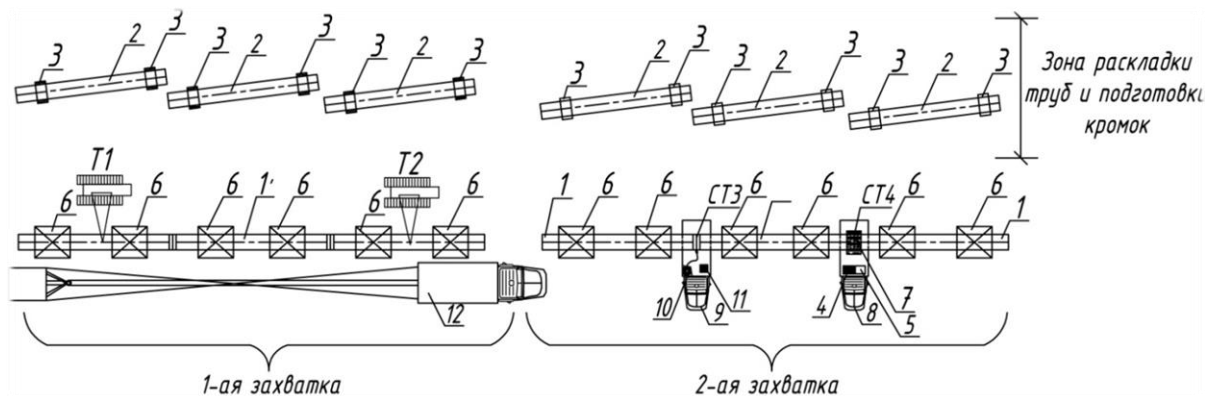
Технологическая схема погрузки готовой плети с монтажных опор на плетевоз при помощи трубоукладчиков: 1-секции труб уложенные на монтажные опоры, 1'- готовая к транспортировке плеть, 2-секции труб на которых выполняется подготовка кромок, 3- инвентарные опоры, 4 - распределитель для управления монтажными опорами, 5- электрогенератор, 6 - монтажные опоры (пат.на ПМ №147232), 7-автоматическая орбитальная установка для монтажа магистрального трубопровода, 8,9 - грузовые машины, 10 – газовый баллон, 11-изоляционный материал для нанесения на сварные стыки магистральных трубопроводов, 12-плетевоз, Т1, Т2- трубоукладчики, СТ3, СТ4- сварные стыки -третий, -четвертый соответственно
